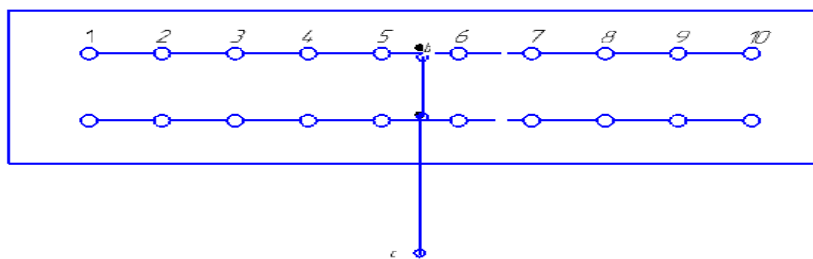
План склада для хранения строительных материалов (М 1:100)
